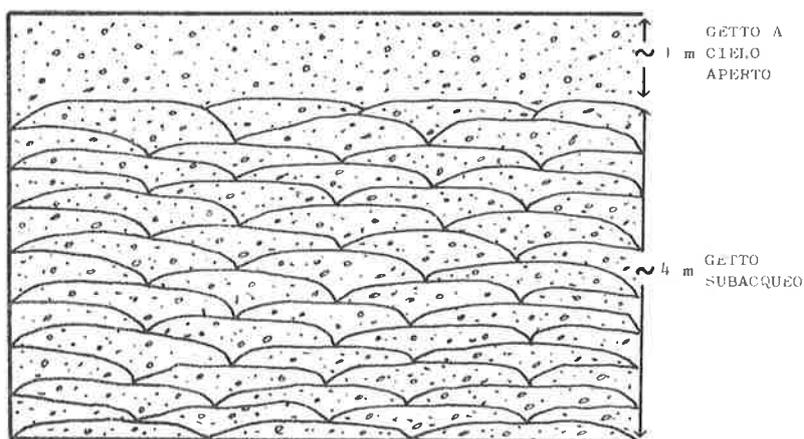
Schema del getto in subacqueo finito con il getto a cielo aperto.
